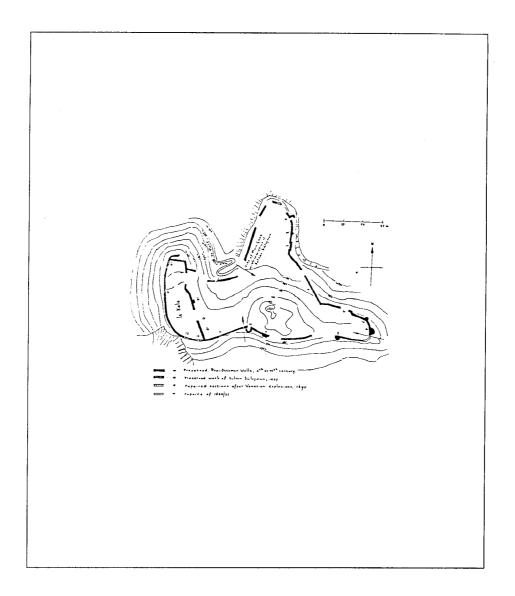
مسقط أفقي لقلعة برفيزه بألبانيا (عن : كيل) .
